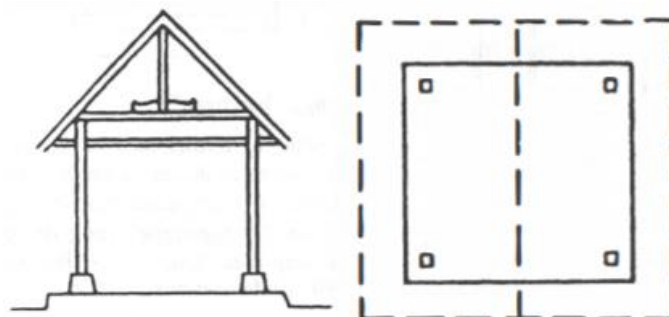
Potongan dan Denah Omah Panggang Pe
